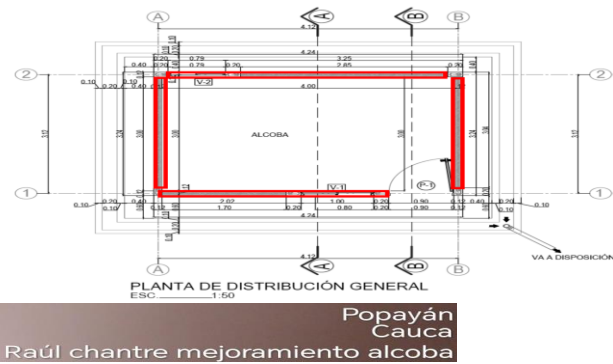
muro con ladrillo tolete macizo, Raúl Chantre (alcoba)
